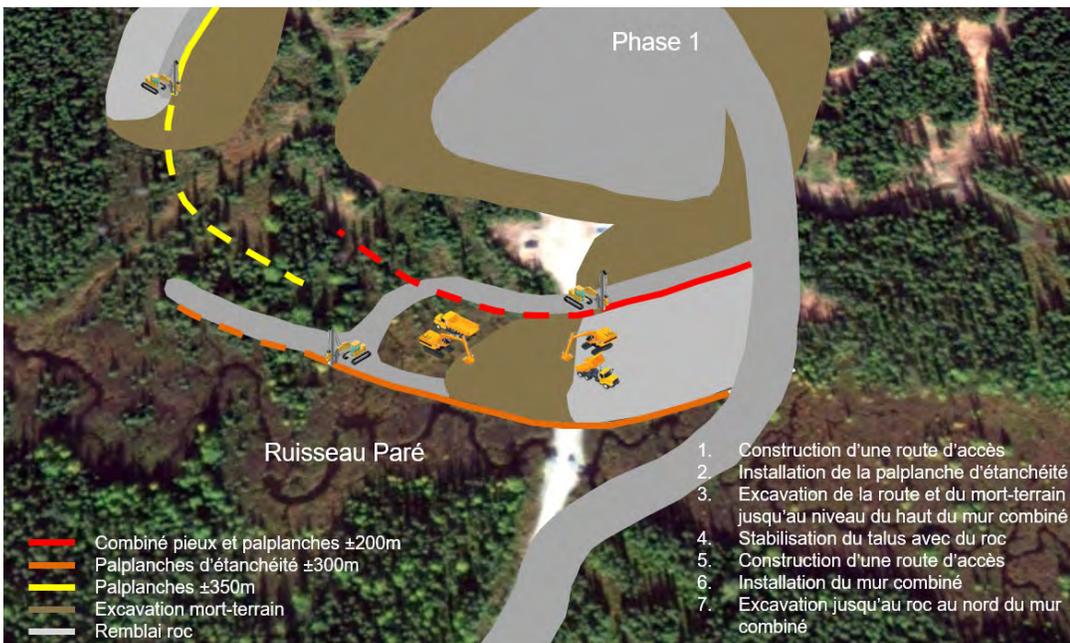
Mur de palplanches et mur combiné pieux et palplanches¹
